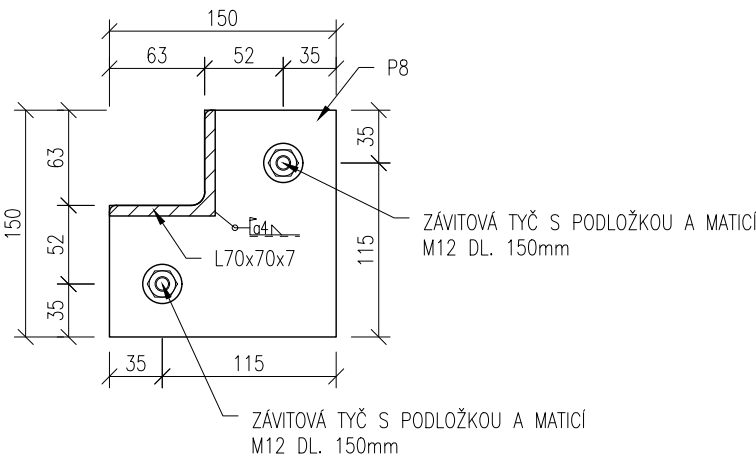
NADPRAŽÍ ŠACHETNÍCH DVEŘÍ
